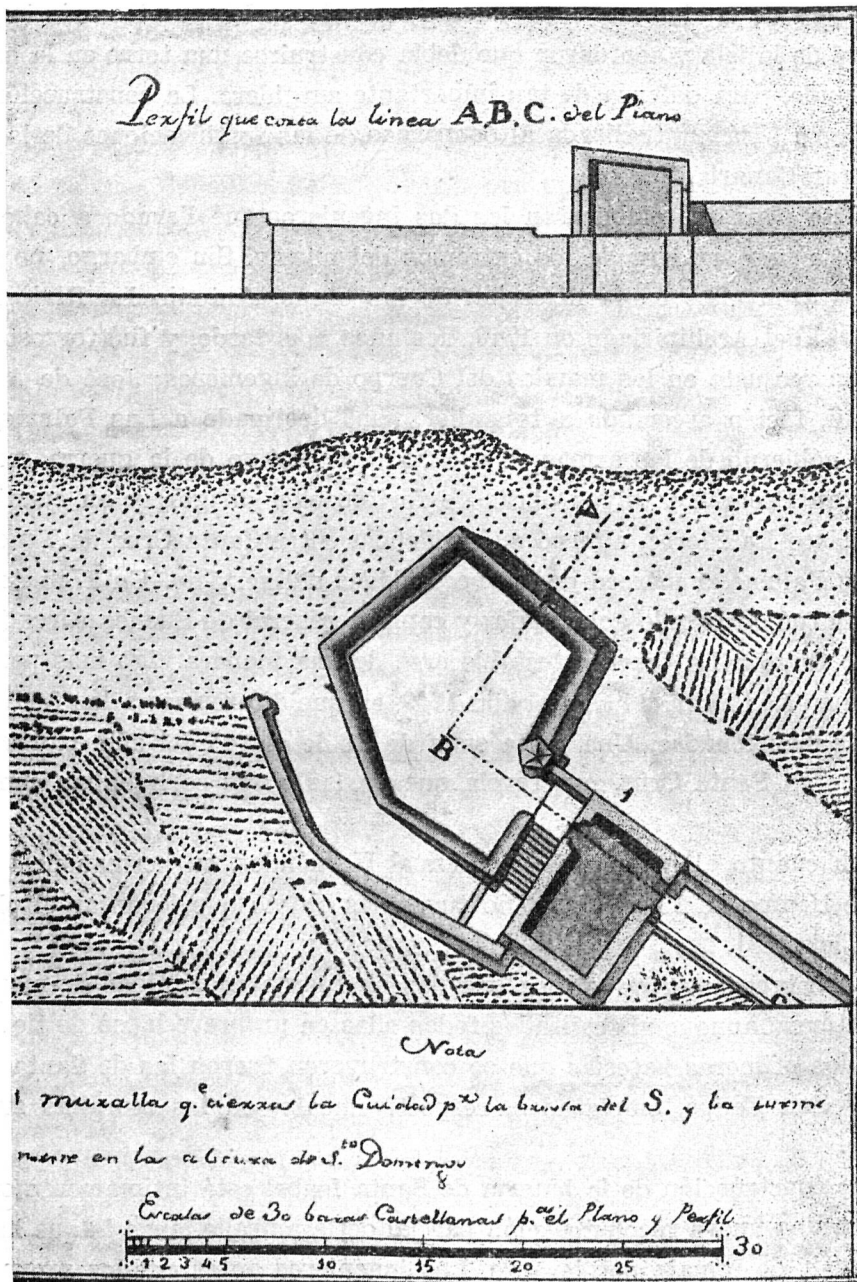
La batería de Santa Isabel. Plano de Hermosilla.
